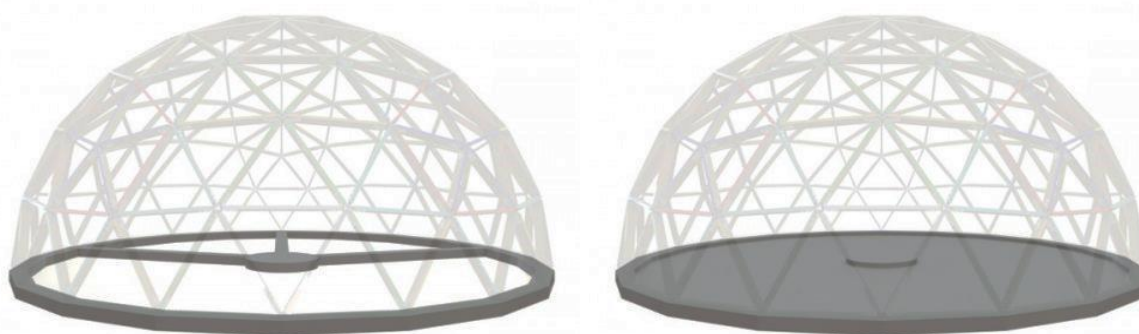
Фундаменты купольных домов: а – ленточный, б – сплошной (плитный)
